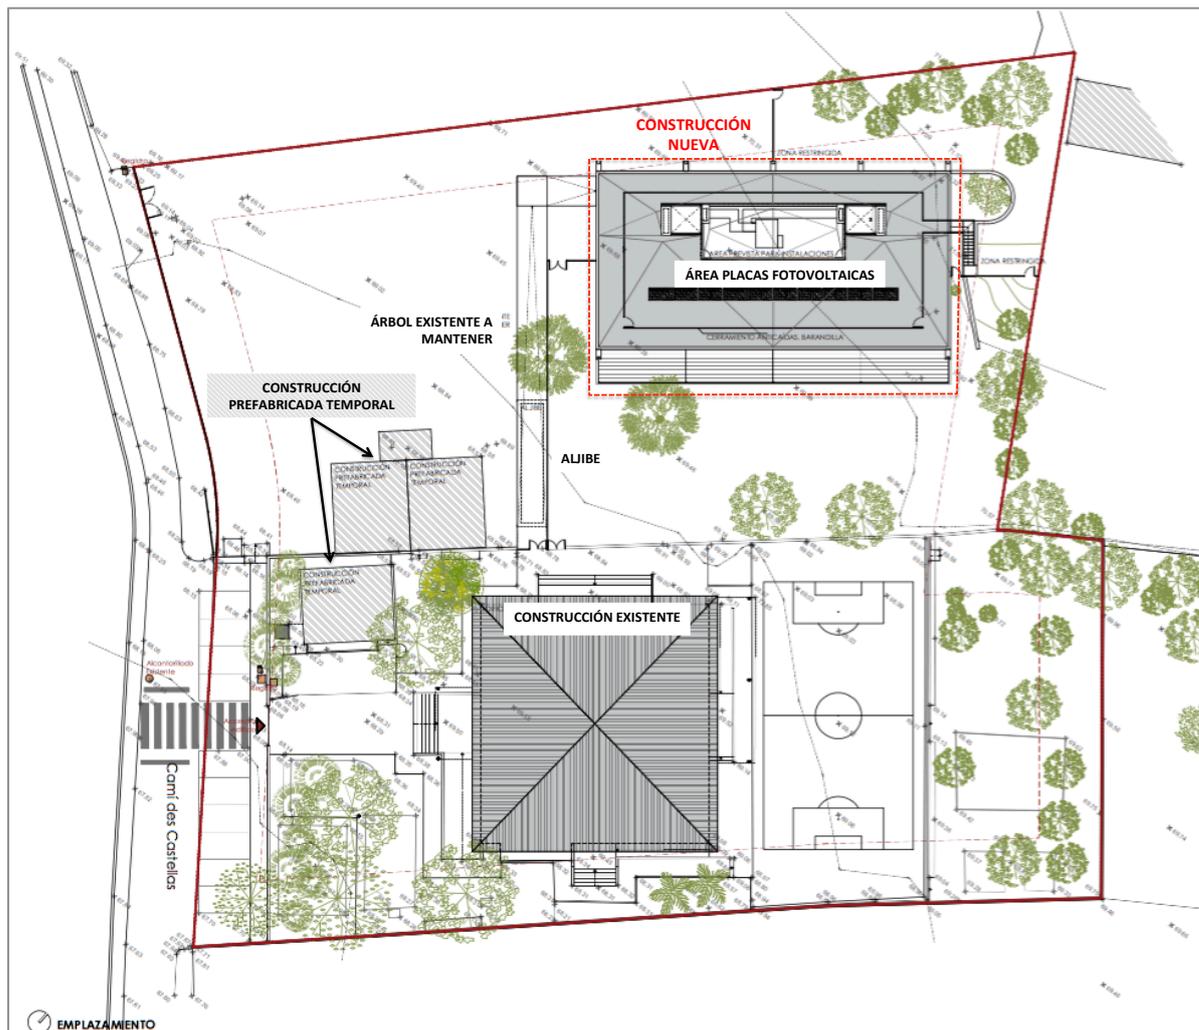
Planta situación. Cubierta (Fuente: proyecto)
